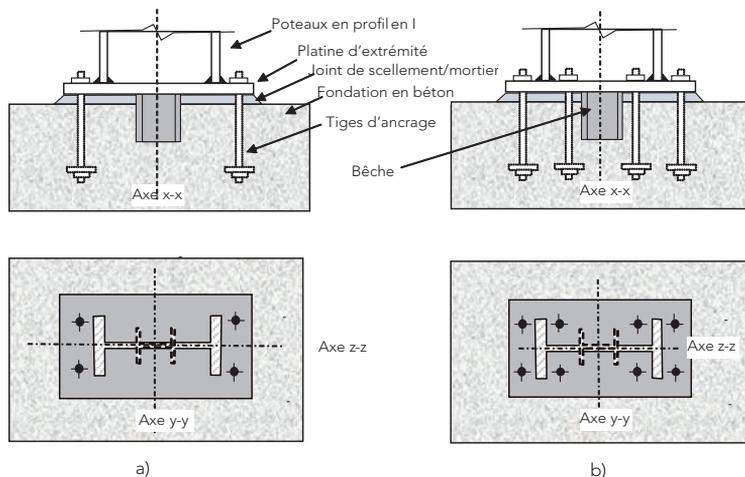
Assemblages de pieds de poteaux dits « encastrés ».
